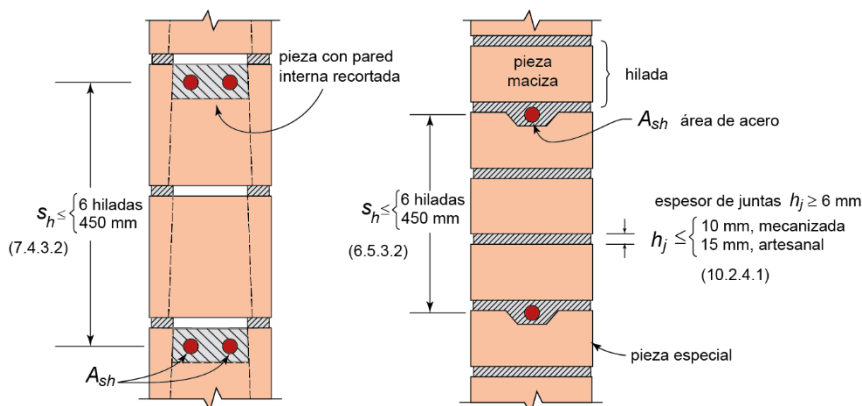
Refuerzo horizontal en piezas especiales
